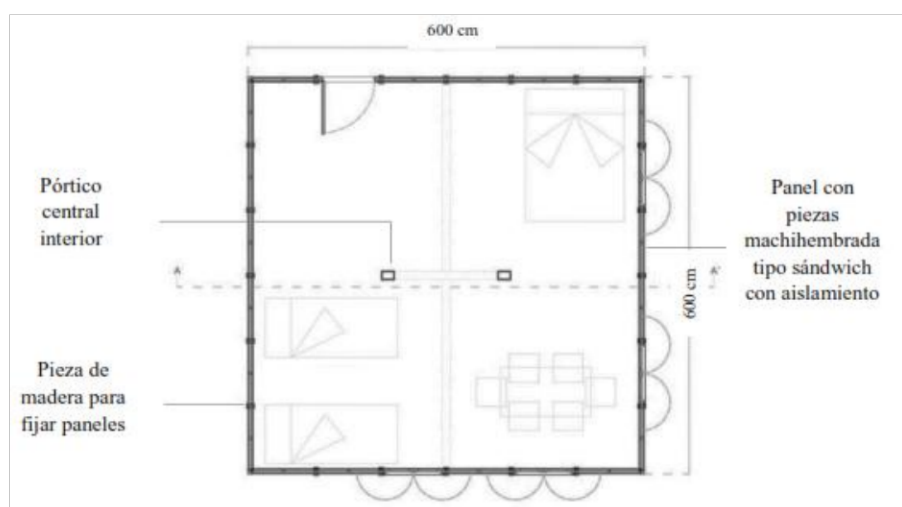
6 X 6 House de Jean Prouvé, planta arquitectónica. Tomada de <https://issuu.com/yurichamblas/docs/solucionesconstructivasaplicadas>
